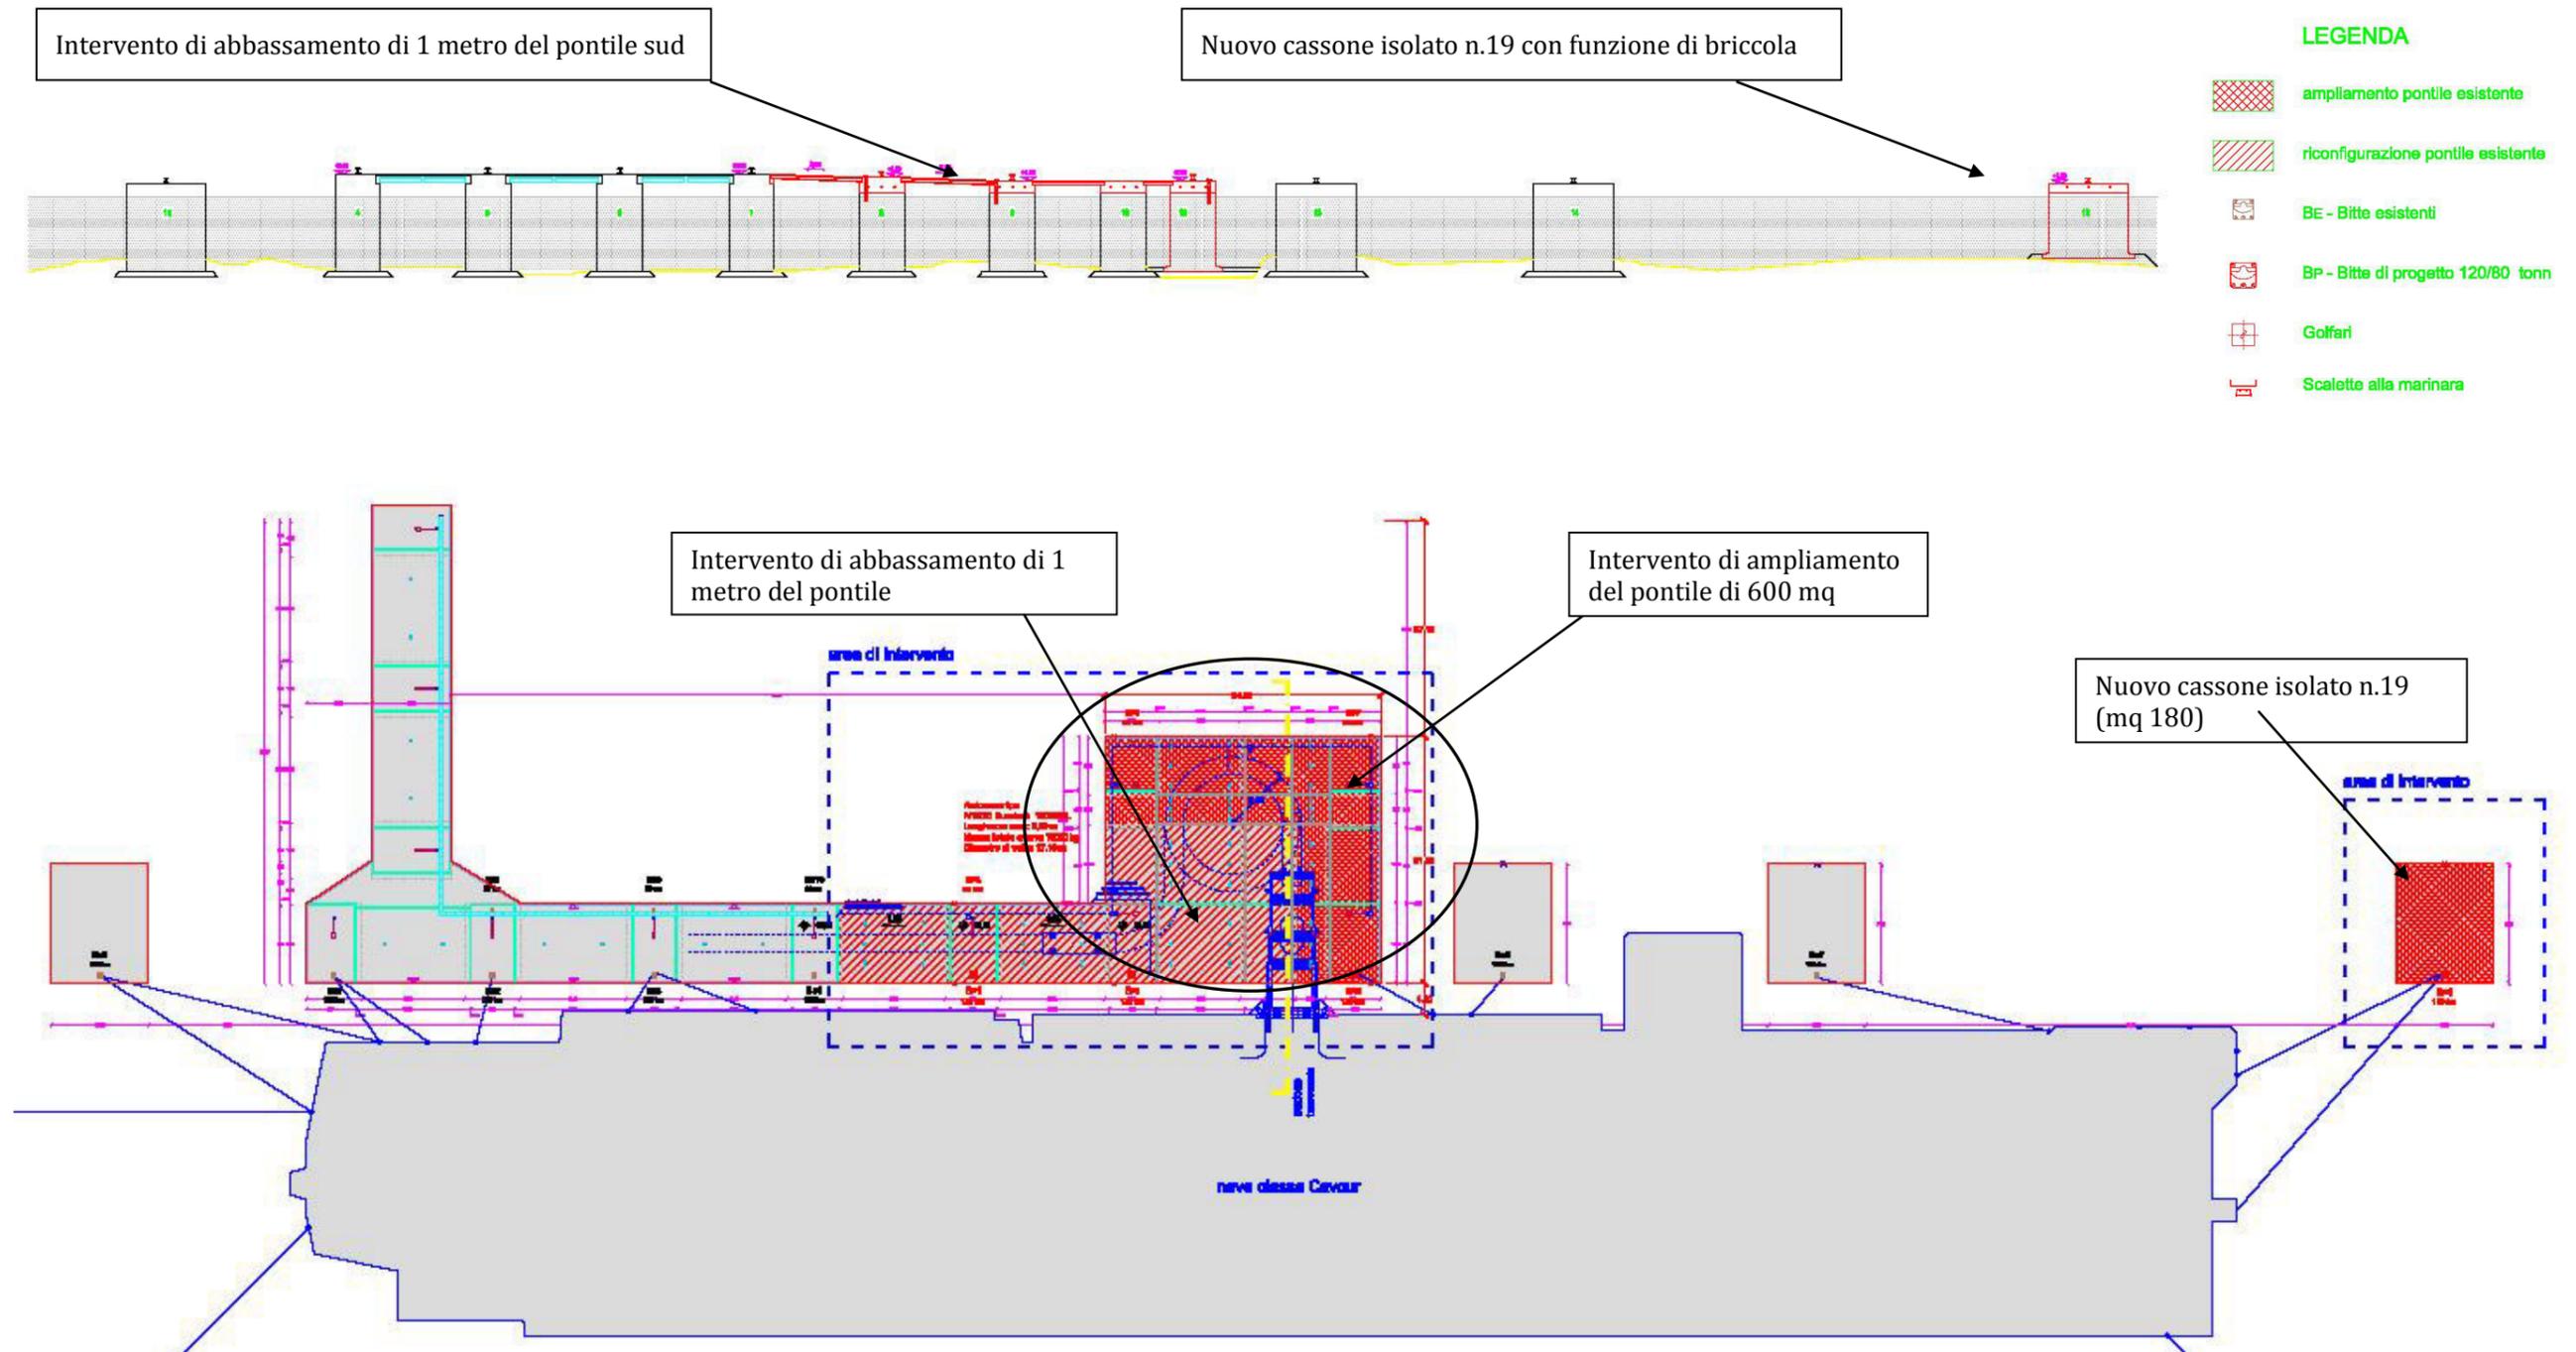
Prospetto e Planimetria intervento di riconfigurazione del pontile sud (non in scala)
